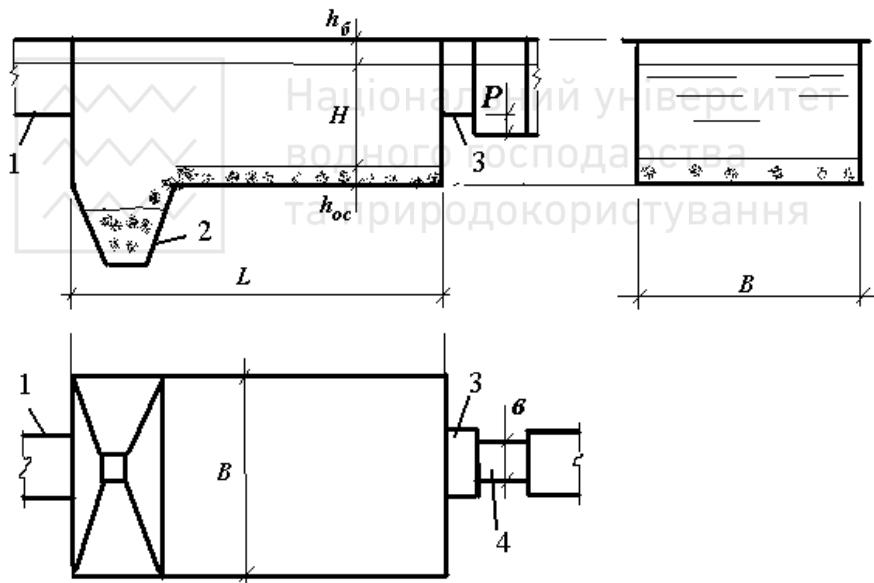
Розрахункова схема горизонтального піскоуловлювача
